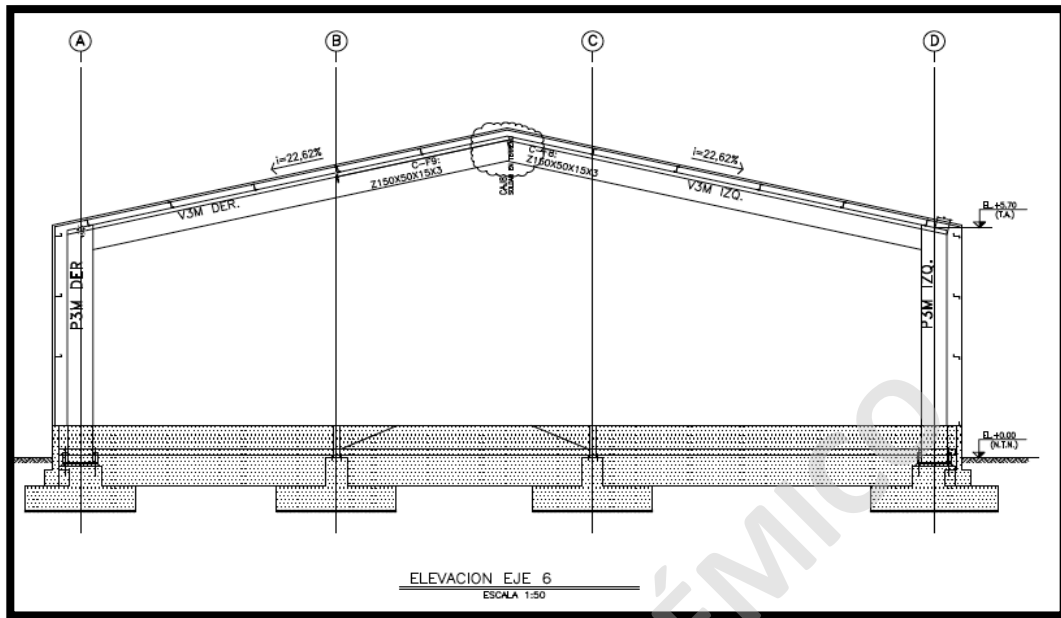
Planos de Montaje ODR Ingeniería y Montajes
